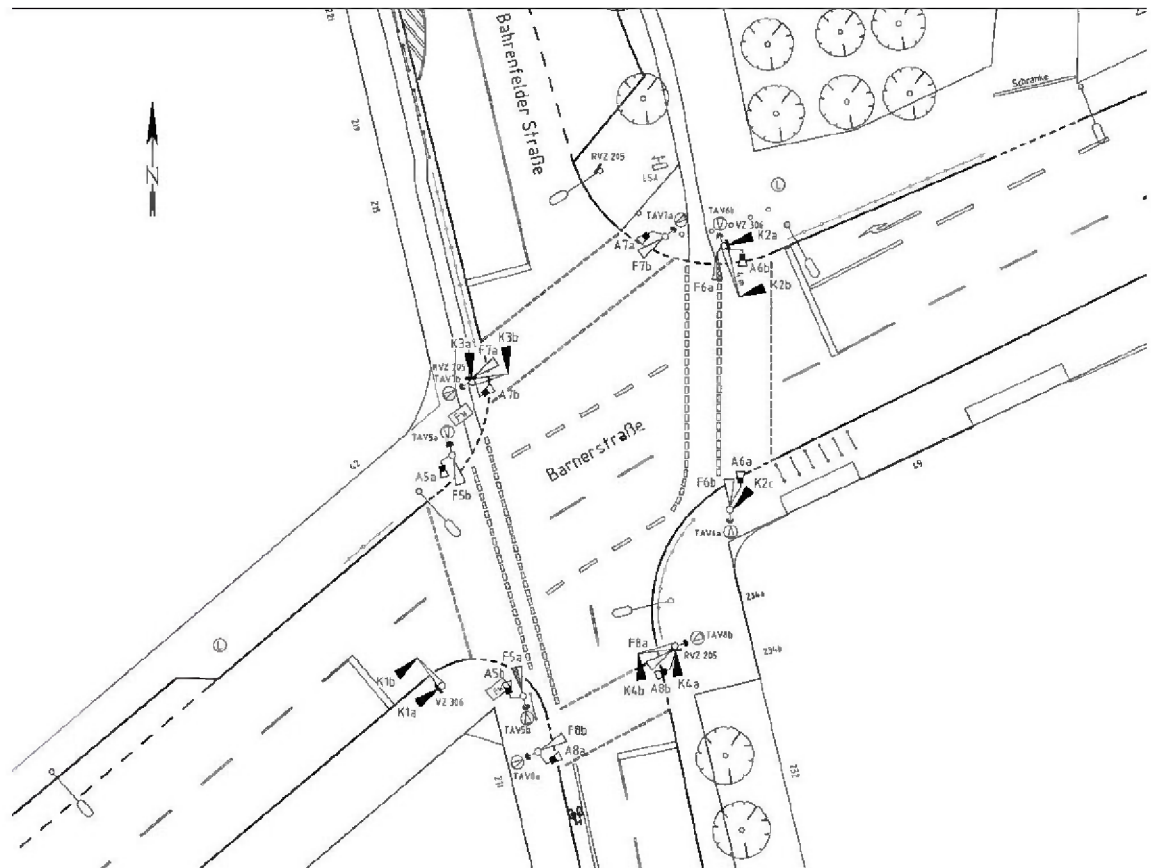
Signallageplan Barnerstraße/Bahrenfelder Straße – Bestand (14/417-04-04/00)
